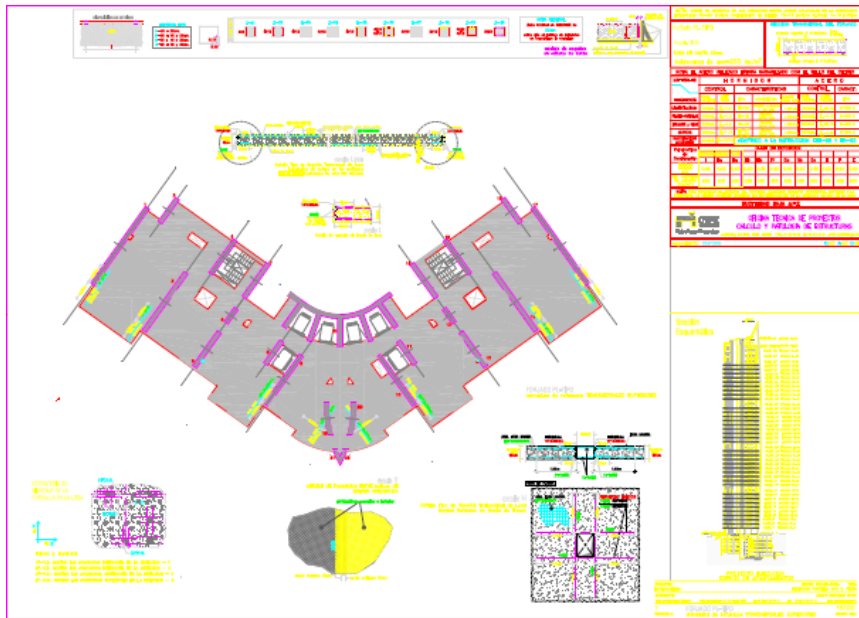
Plano estructura planta tipo.2005.Edifesa
